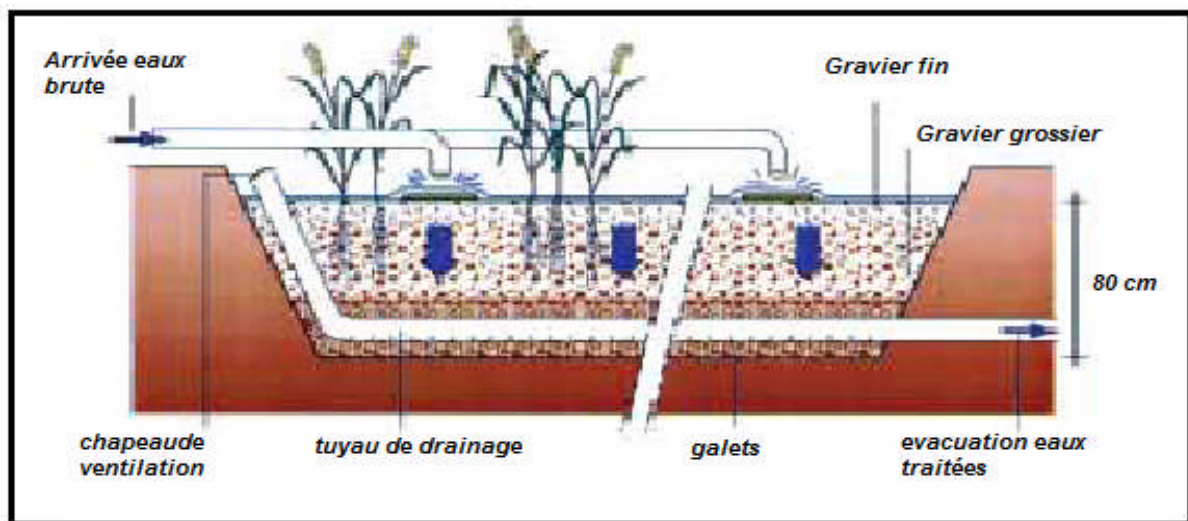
Coupe transversale d'un filtre planté à écoulement vertical.
